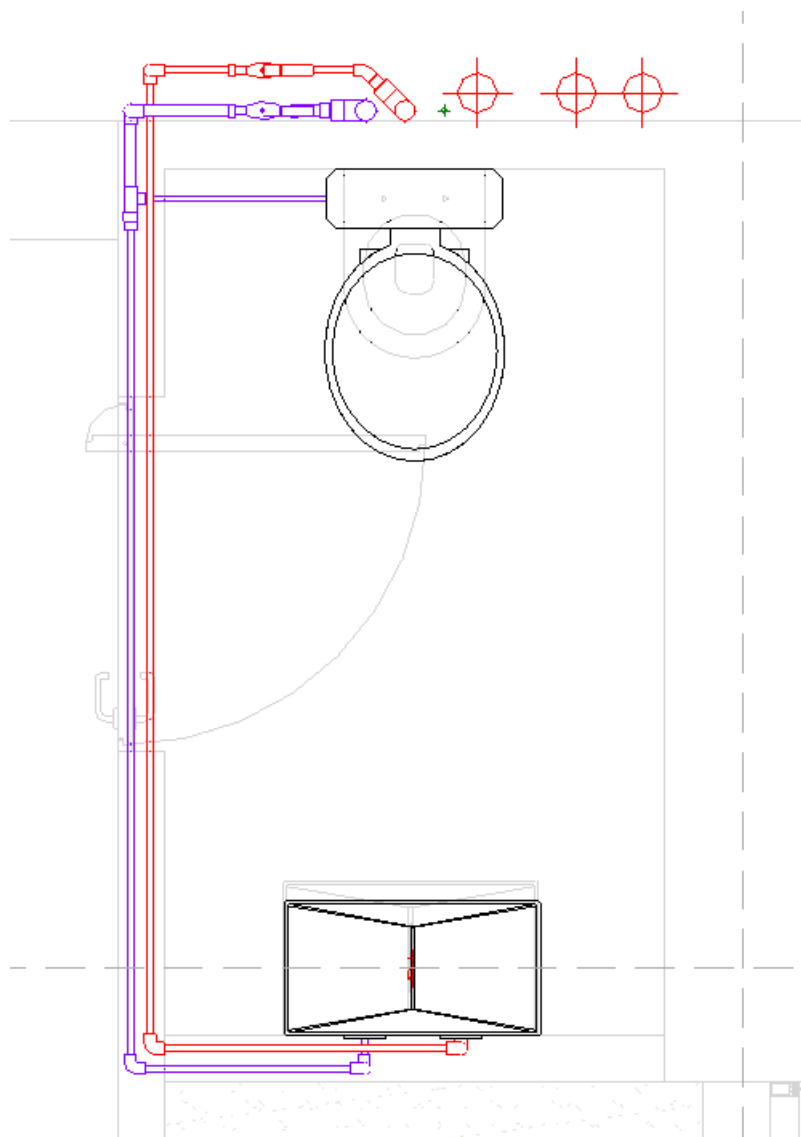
Divisão (1) em planta do piso 1 da rede predial de abastecimento
